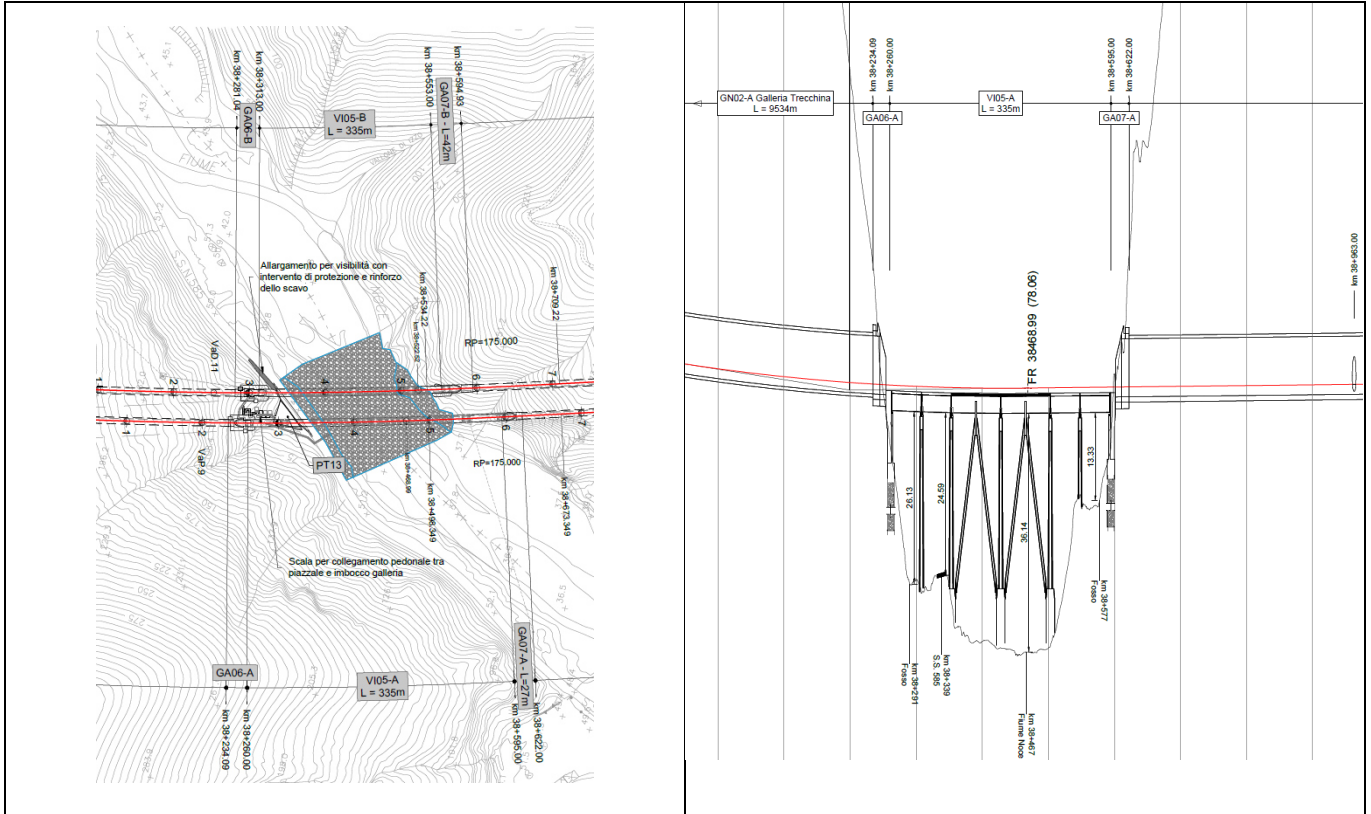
Planimetria e profilo di progetto VI05 da km 38+260 al km 38+595 BP
